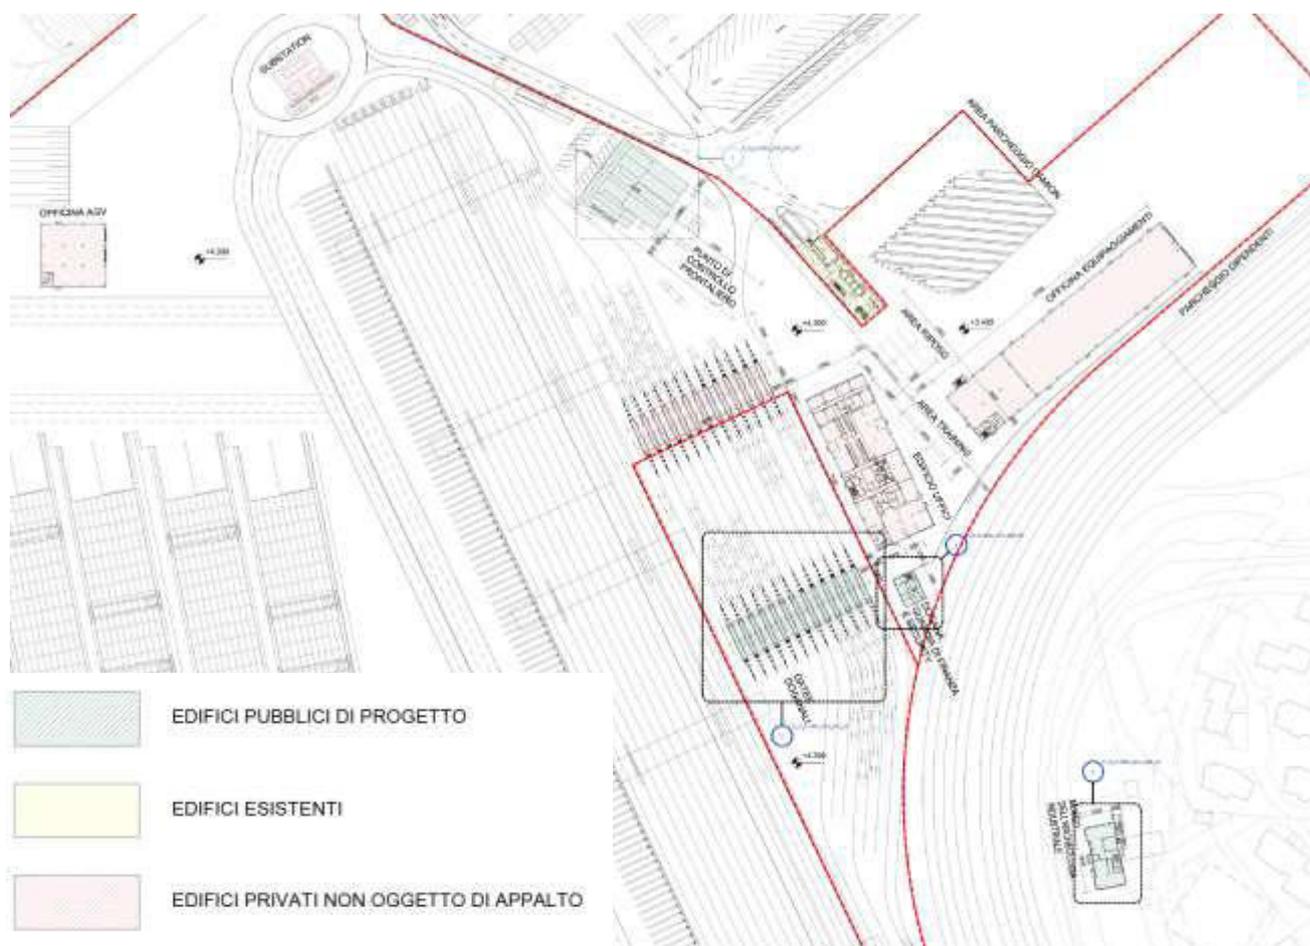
planimetria inquadramento edifici (cfr. elaborato 5EDF\_P\_G\_E-ARC\_4FA\_001\_07\_01 "Architettura - Planimetria edifici")
